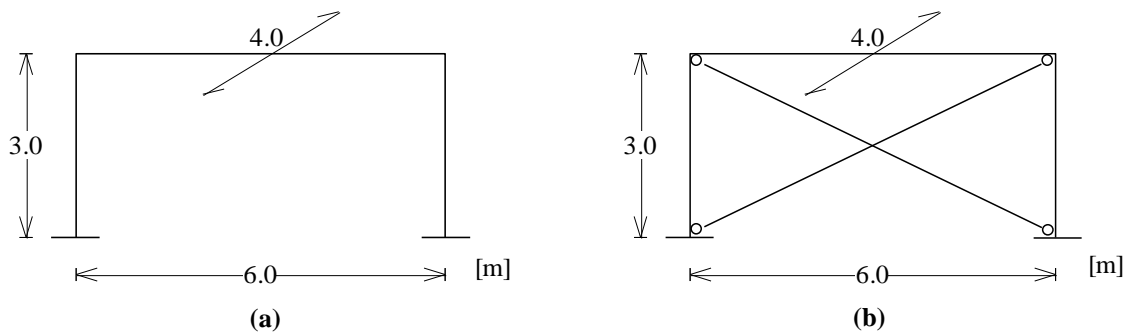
Pórticos de Betão Armado de 1 piso: (a) não contraventado (b) contraventado..
